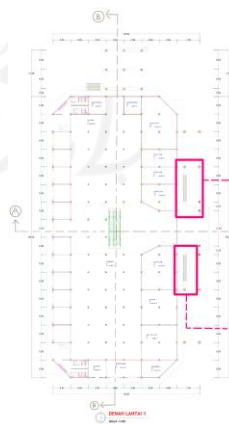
13 Ramp Eksisting Pada Entrance Bangunan
